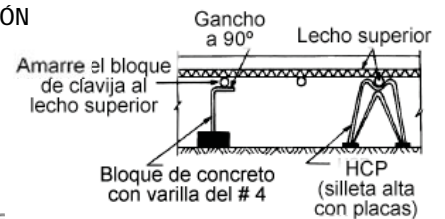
SOPORTE DE VARILLA PARA LOSAS DE CIMENTACIÓN
